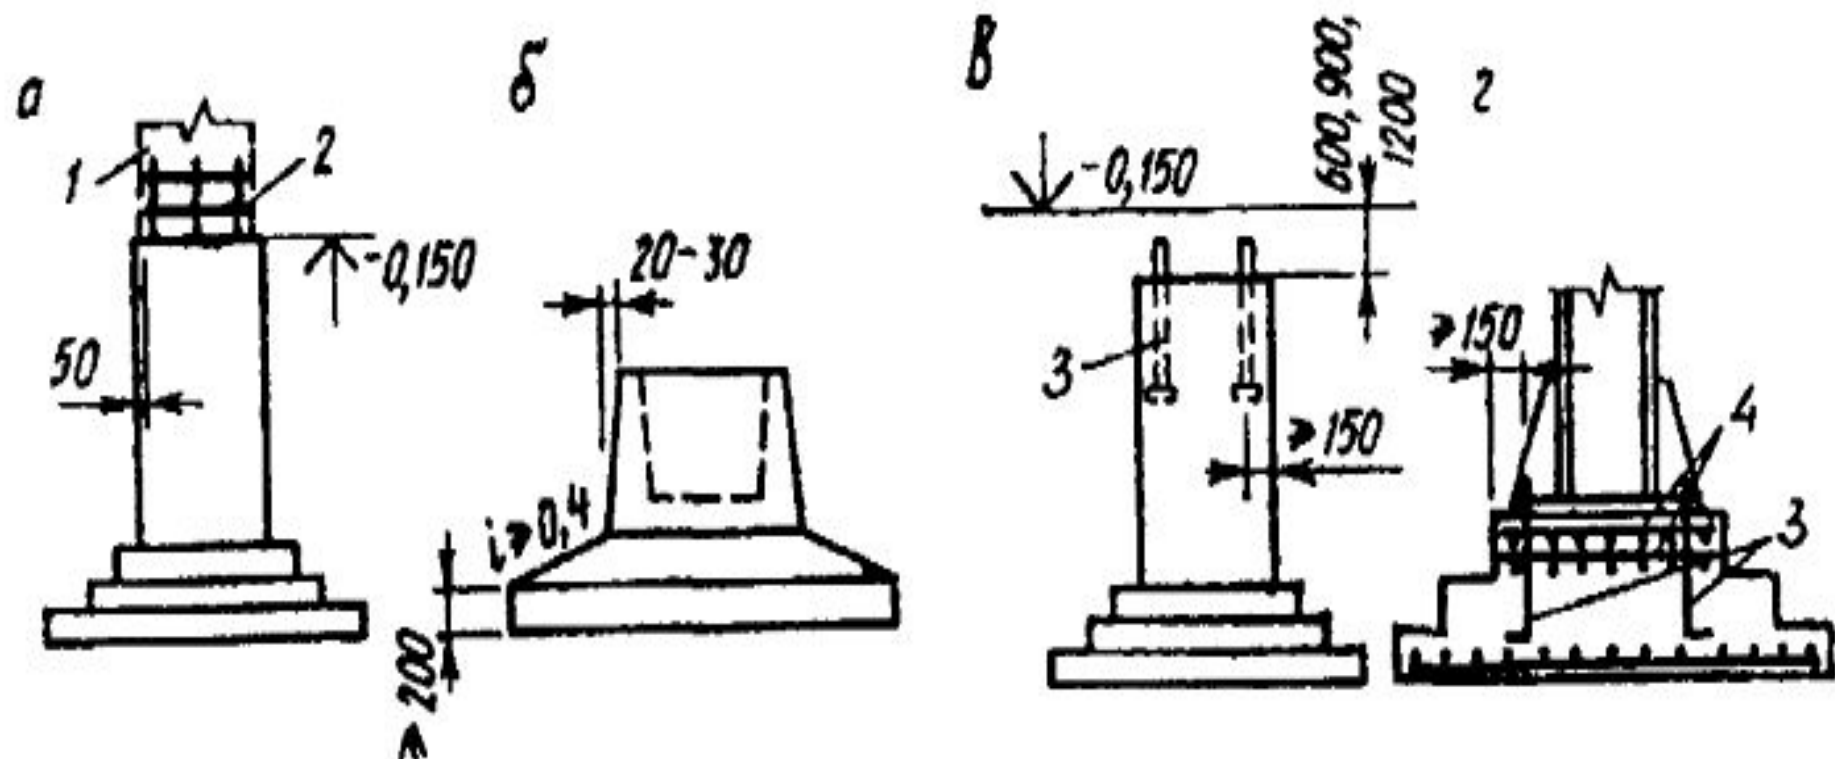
Типы монолитных фундаментов: а – под монолитную колонну; б – с подстаканником под сборную колонну; в – под сборную колонну с закладными деталями; г – под металлическую колонну; 1 – колонна; 2 – выпуски арматуры; 3 – анкерные болты; 4 – арматурные сетки
